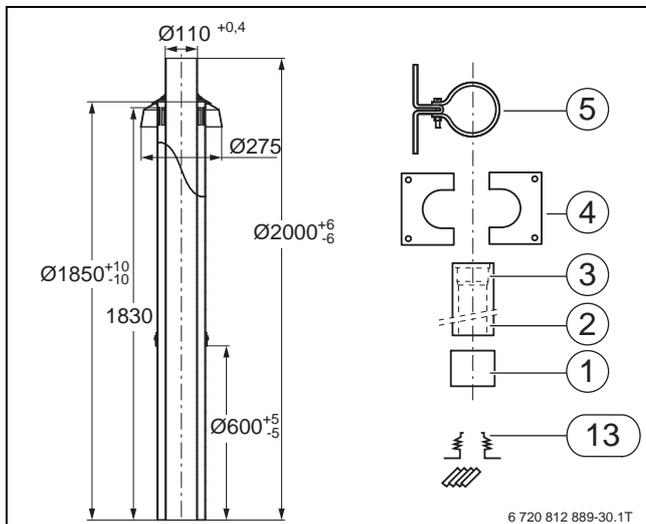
Bauteile des Grundbausatzes DO aus Kunststoff (Maße in mm)
